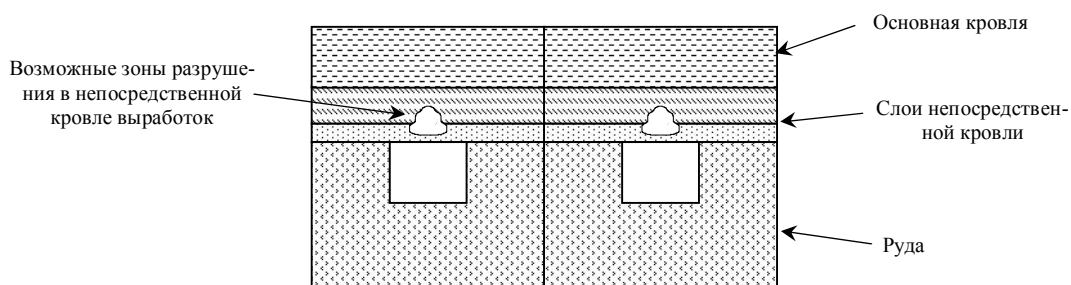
Схема размещения разрушенных областей в слоистой непосредственной кровле системы расположенных на глубине 250 м прямоугольных в плане выработок
